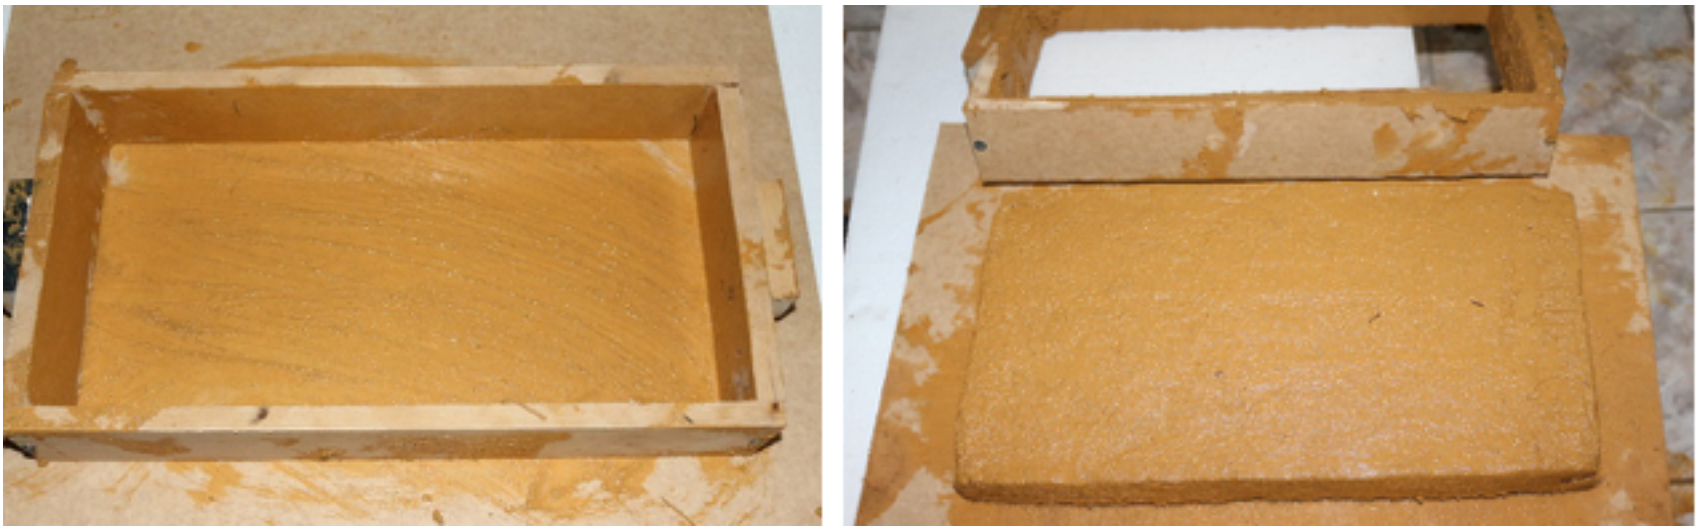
Moldagem e desmolde do tijolo antes de ser dividido em 4 partes. Fonte: Bittencourt; Silva.
